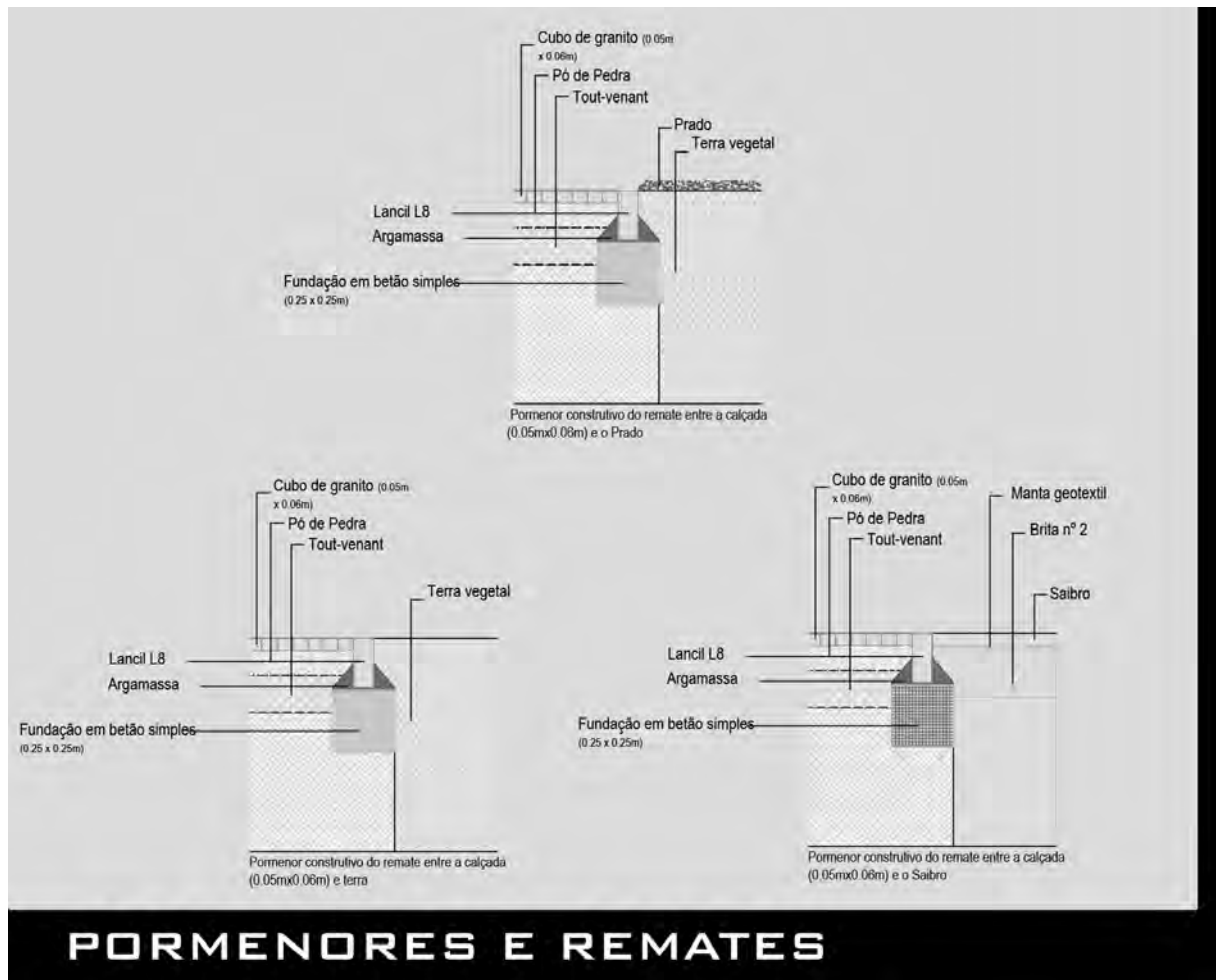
Pormenores e remates do plano de pavimentos. S/escala. Fonte Autor
